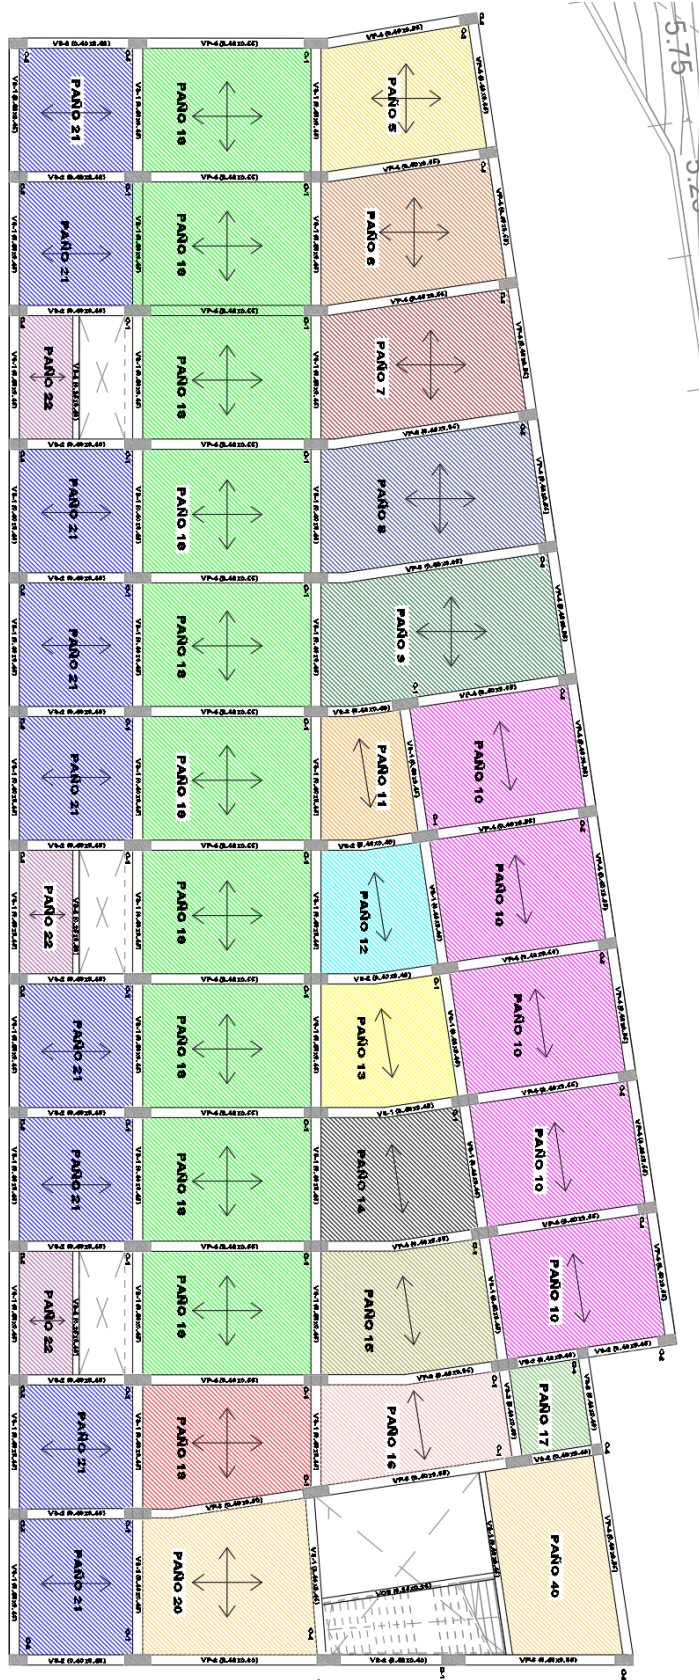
planta sótano -2 y sótano - 1 (BLOQUE 2)
